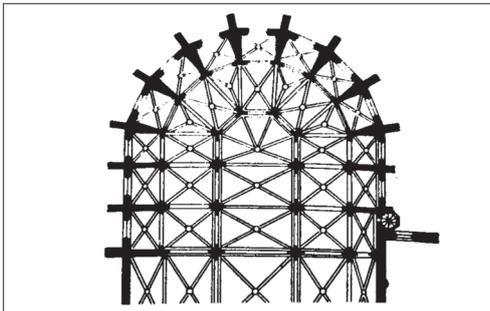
Grundriss Chores der Zisterzienserkirche in Zwettl, Österreich
